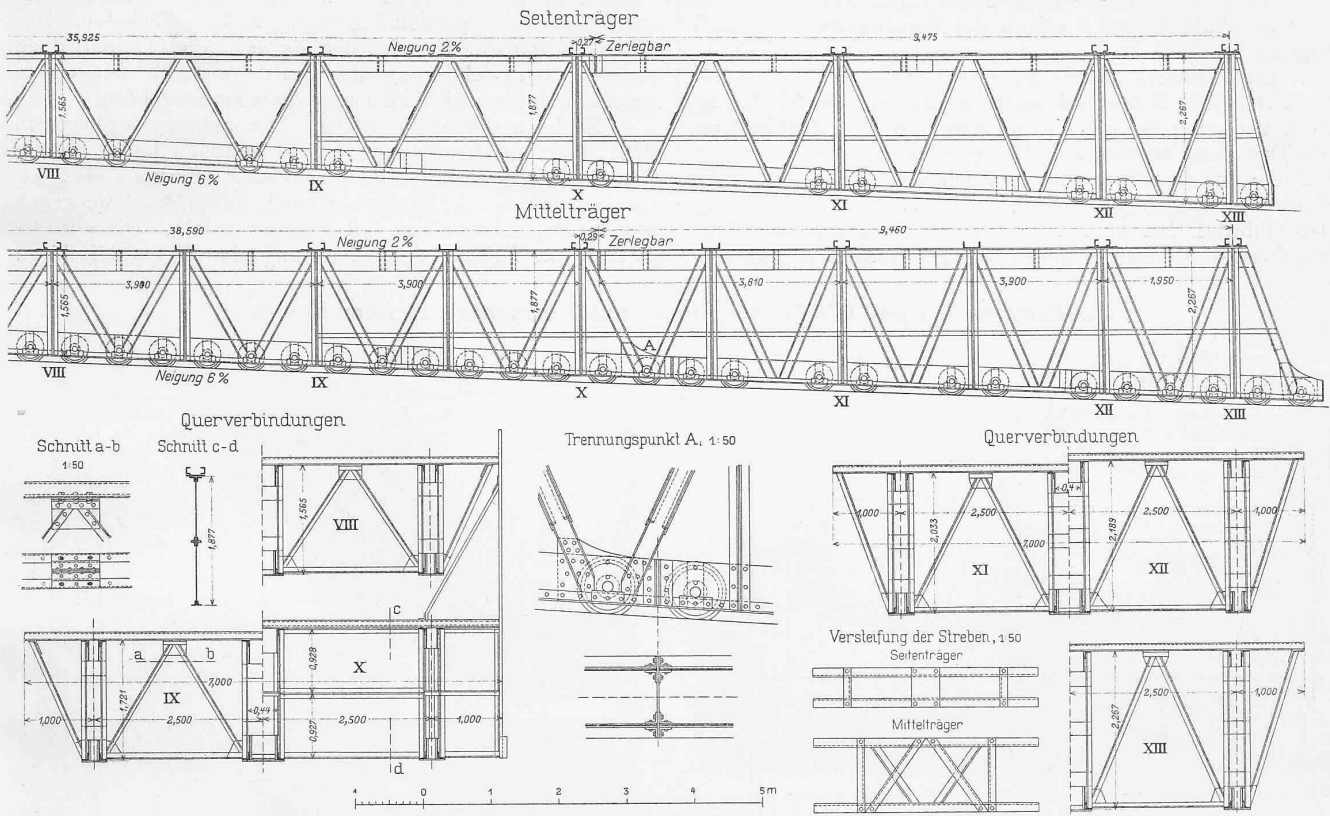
Unterer Teil des Aufzugwagens, Ansichten und Querschnitte. — 1 : 100. — Details. — 1 : 50.
